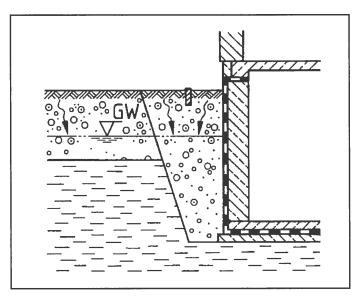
Bauwerksabdichtung nach DIN 18195 T 6
